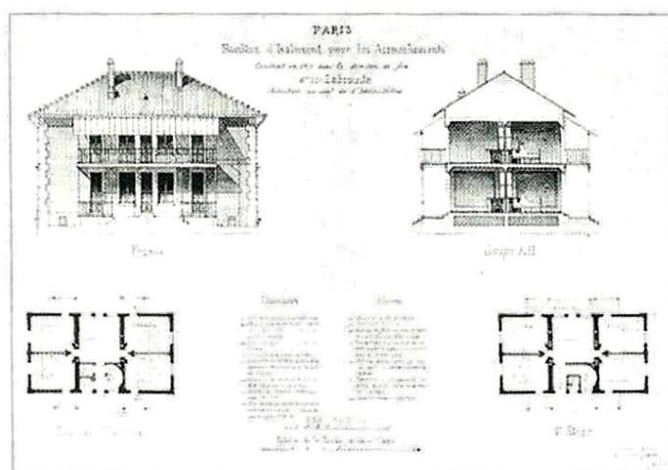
Fachada, corte e planta baixa. Pavilhão de Isolamento da Maternidade de Paris, 1875.
